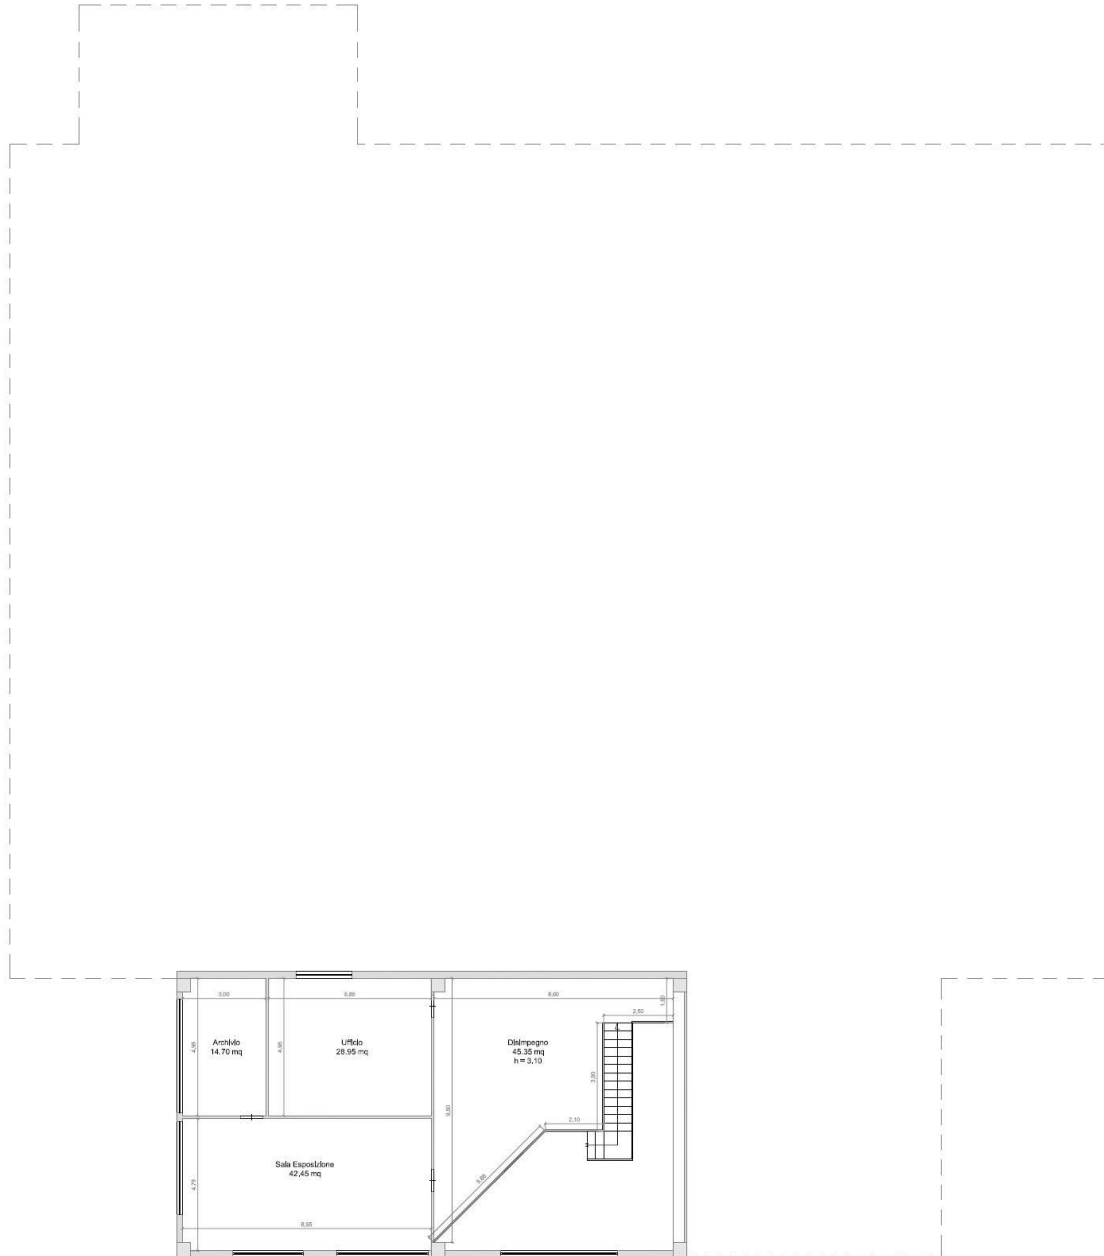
Planimetria Catastale Foglio 39, p.lla 370, Piano Terra.
